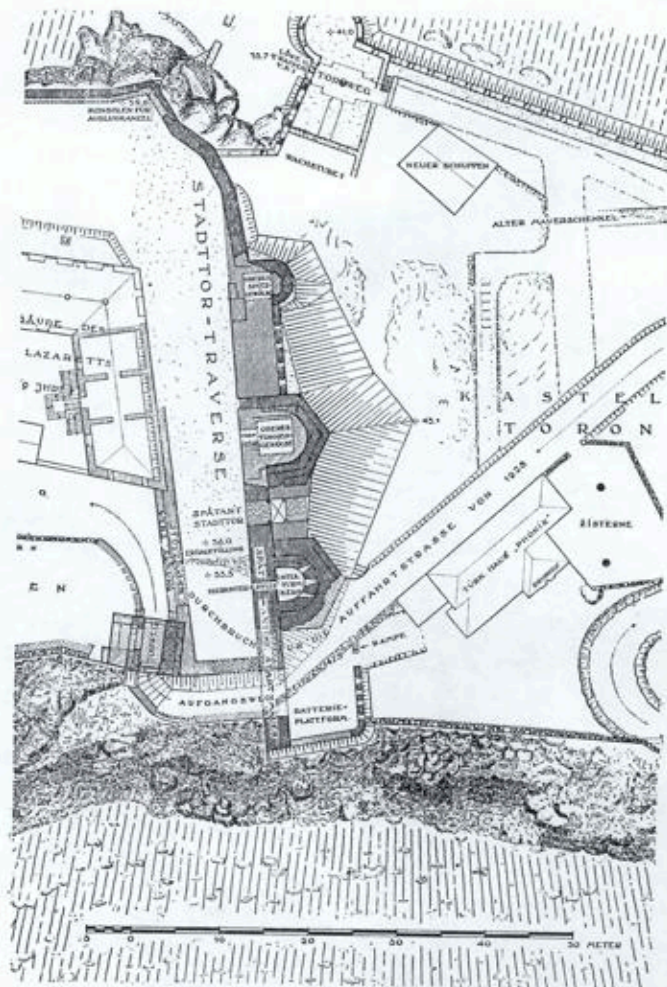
Akronauplia, spätantike Stadtmauer mit Toranlage; Grundriß (genordet)
